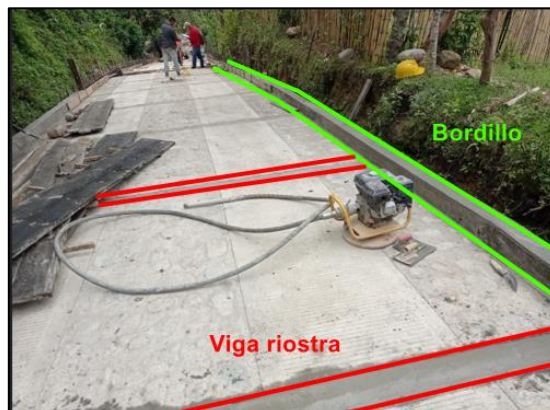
Fundición de concreto ciclópeo 60% concreto de 21Mpa y 40% piedra, San Miguel, Páez
